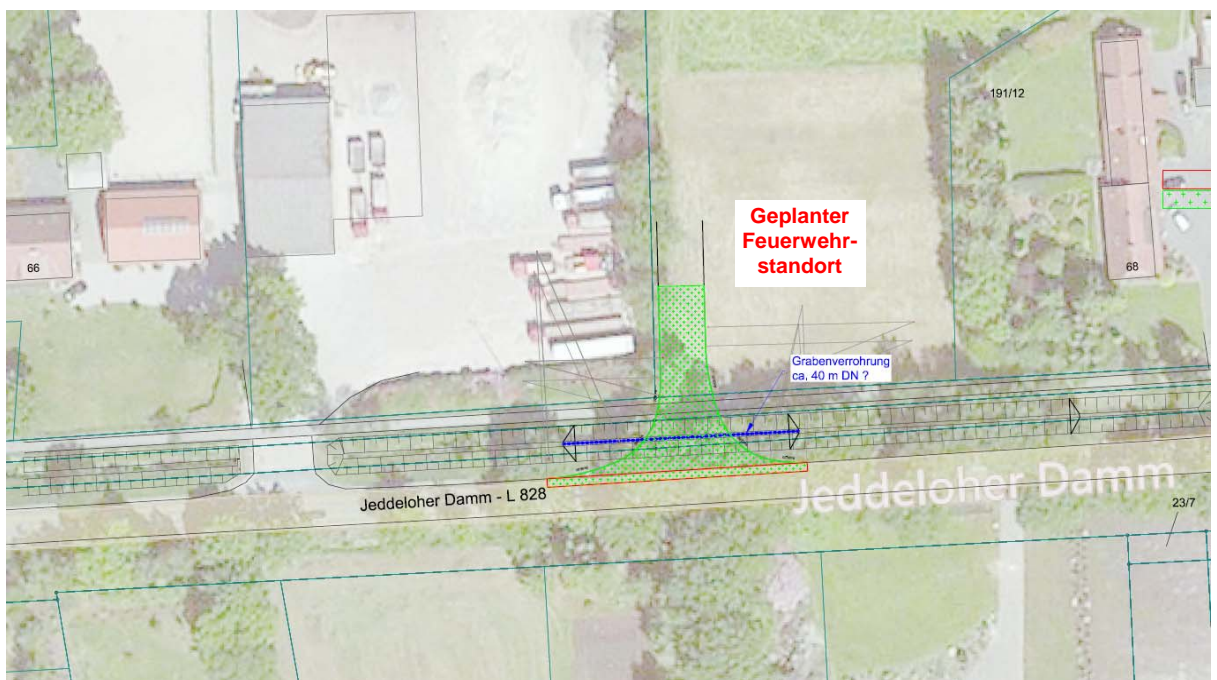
Lageplan Grundstückszufahrt Feuerwehr (Ingenieurbüro Börjes)
